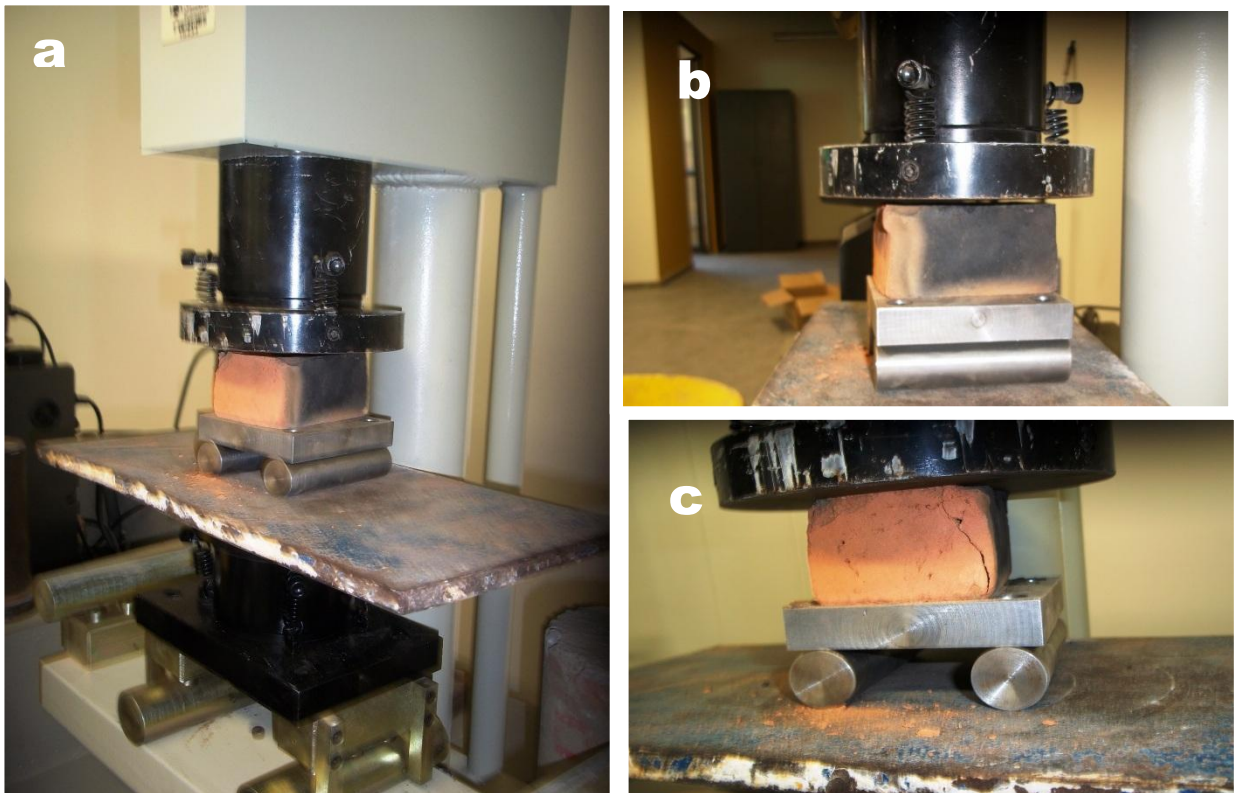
Montaje ensayo de compresión: A) Ubicación ladrillo en la máquina, B) aplicando la carga puntual y C) Fractura generada por la compresión. Fuente: Autor
